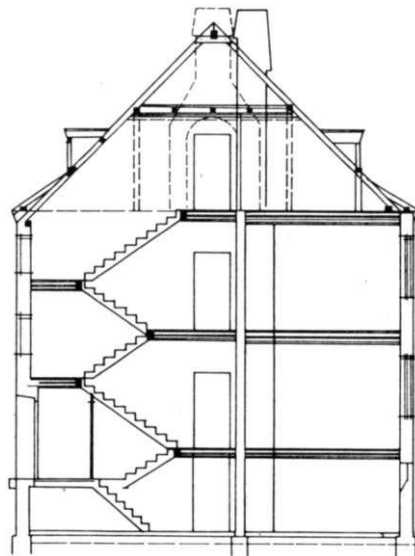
Brunnerstraße 3, Typ I, Haus 1 u. 2
